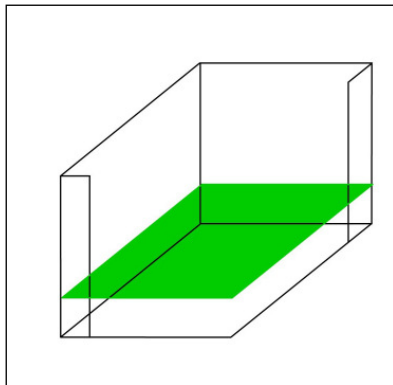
Raum mit Grundrissebene in Höhe von ca. einem Meter.
